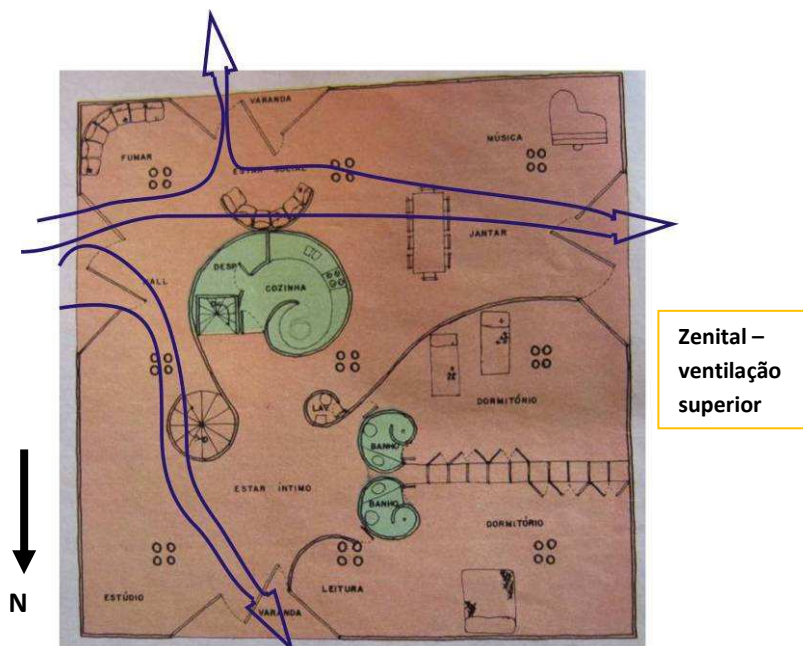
Residência Abrão Assad: planta esquemática do pavimento superior.
